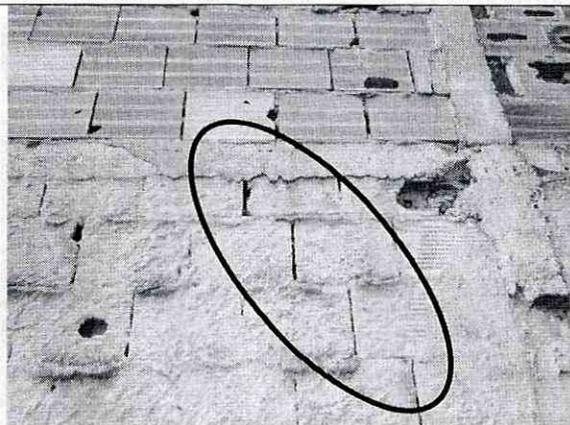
Fisura escalonada, sigue la pega entre bloques.
